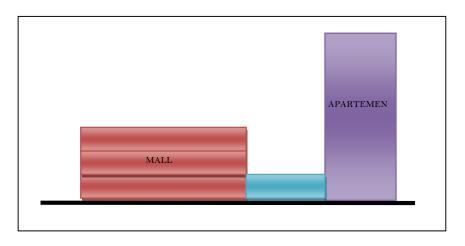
Denah pemisahan entrance mall dan entrance apartemen (Alternative 01)
